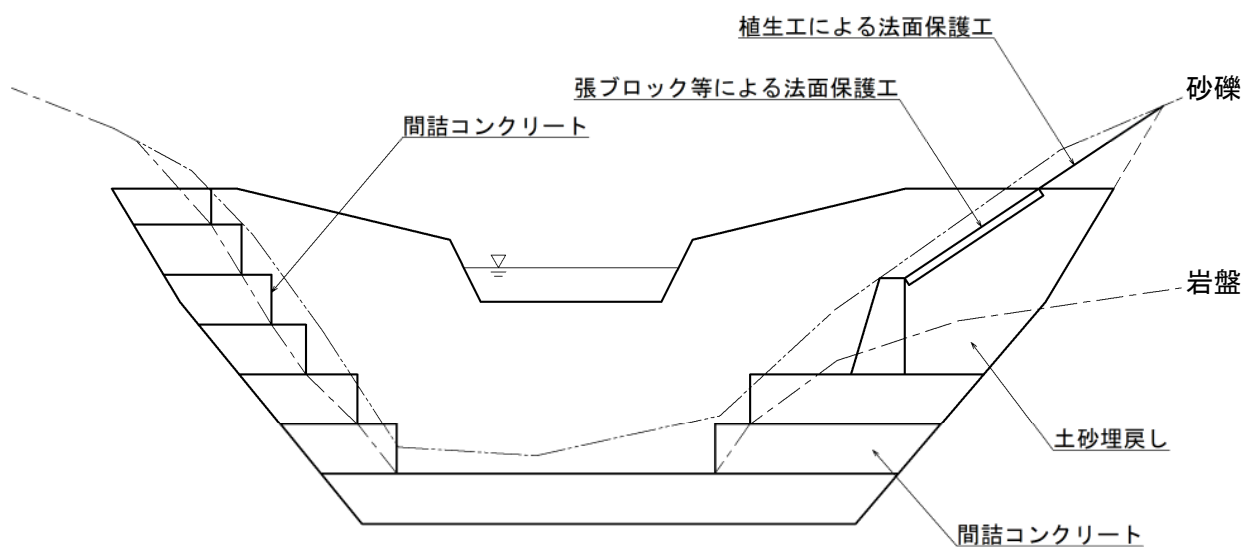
V-3 岩盤及び岩盤+砂礫地盤における間詰工配置例
